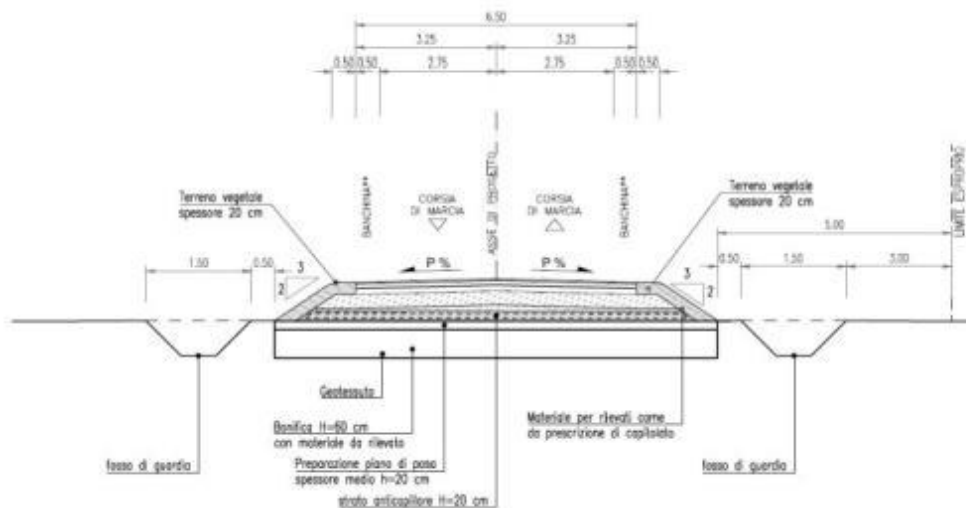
Sezione strada locale a destinazione particolare ovest in rettilineo
